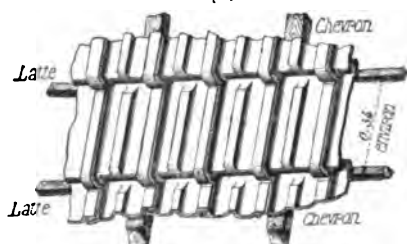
Pan de toiture couvert en tuiles Muller.
